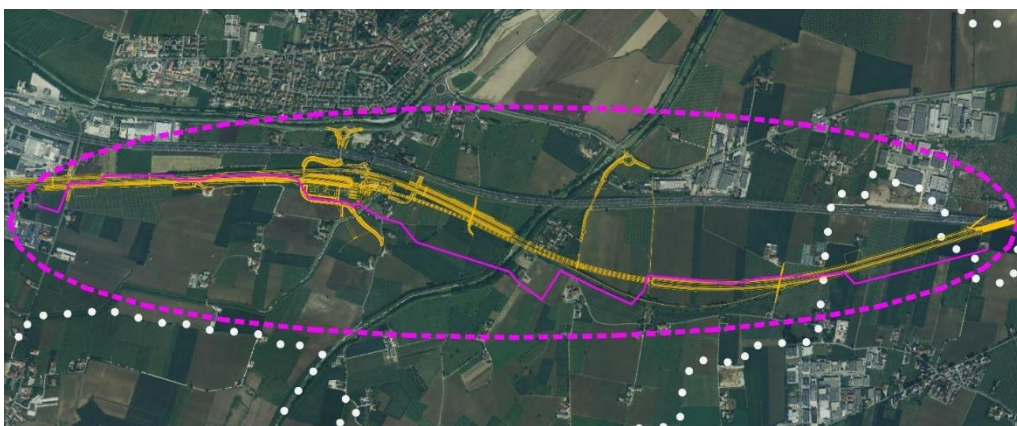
Stralcio Tavola Individuazione su ortofoto, con indicazione delle aree interessate dalla variante..
